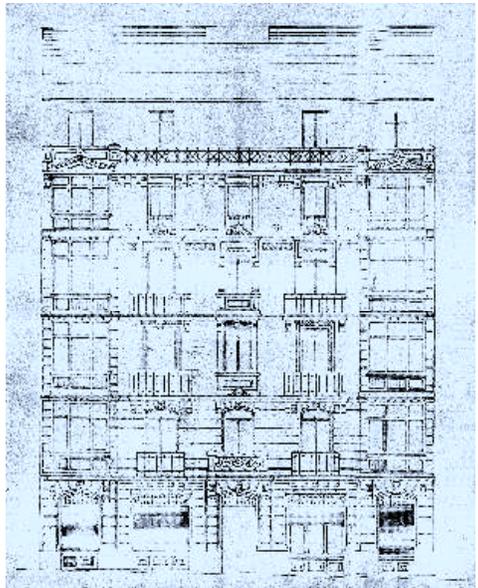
Alzado de la fachada principal de la Casa de Toribio Larrea en Bilbao.
